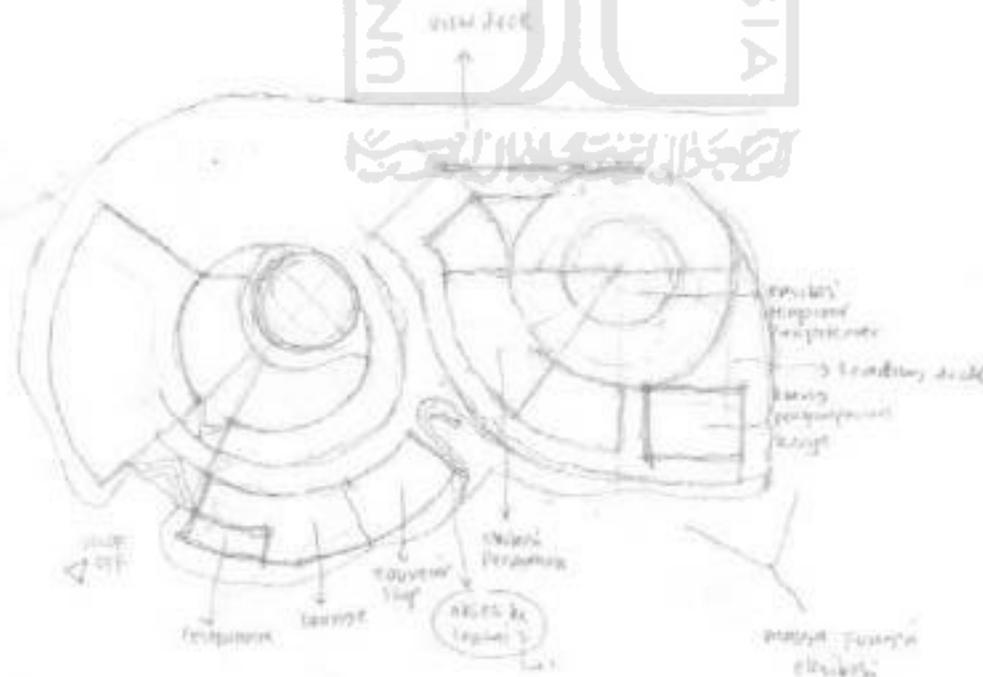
Massa Bangunan dengan Vegetasi Peneduh
